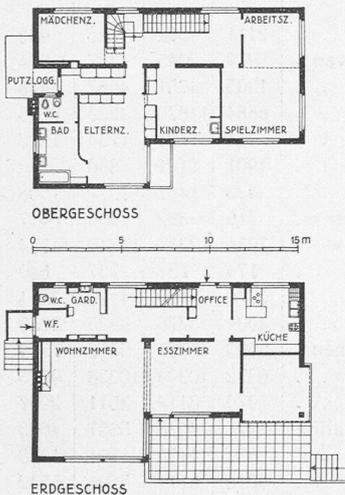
Wohnhaus Arch. Egidius Streiff, Zürich. — Grundrisse 1 : 400.
